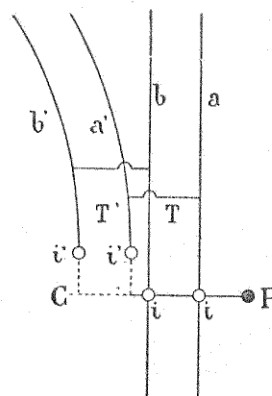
Schéma d'un aigillage des tramways de Lugano.
